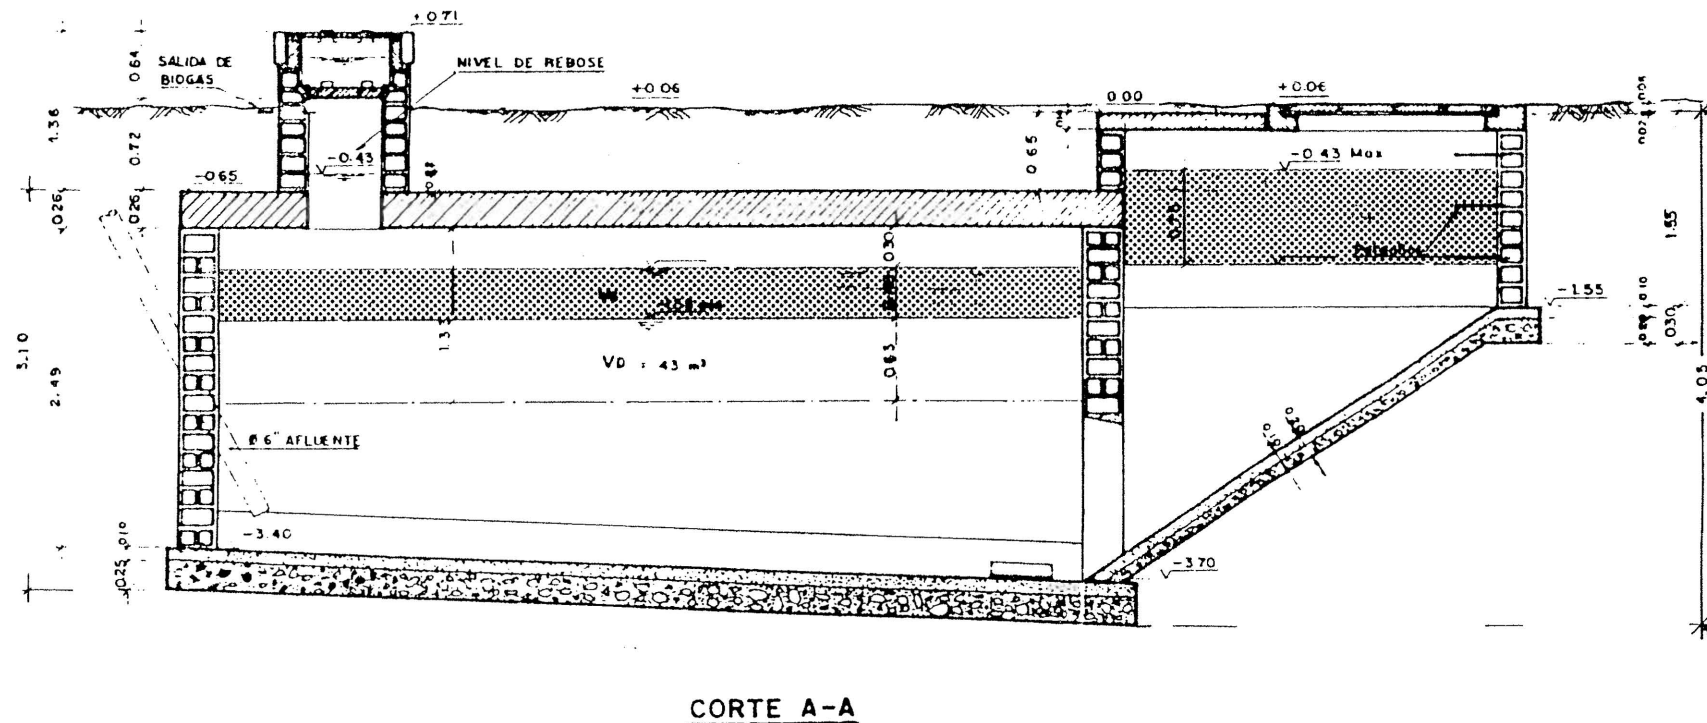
Anaerobe Abwasserreinigungsanlage nach dem MDB-System auf der Finca von Sr. Arcesio Díaz, Palmira, Kolumbien. Längsschnitt durch die Festdomanlage in Tunnelbauweise mit Ausgleichbecken (Schlammbehandlung). Inbetriebnahme Ende 1988.
